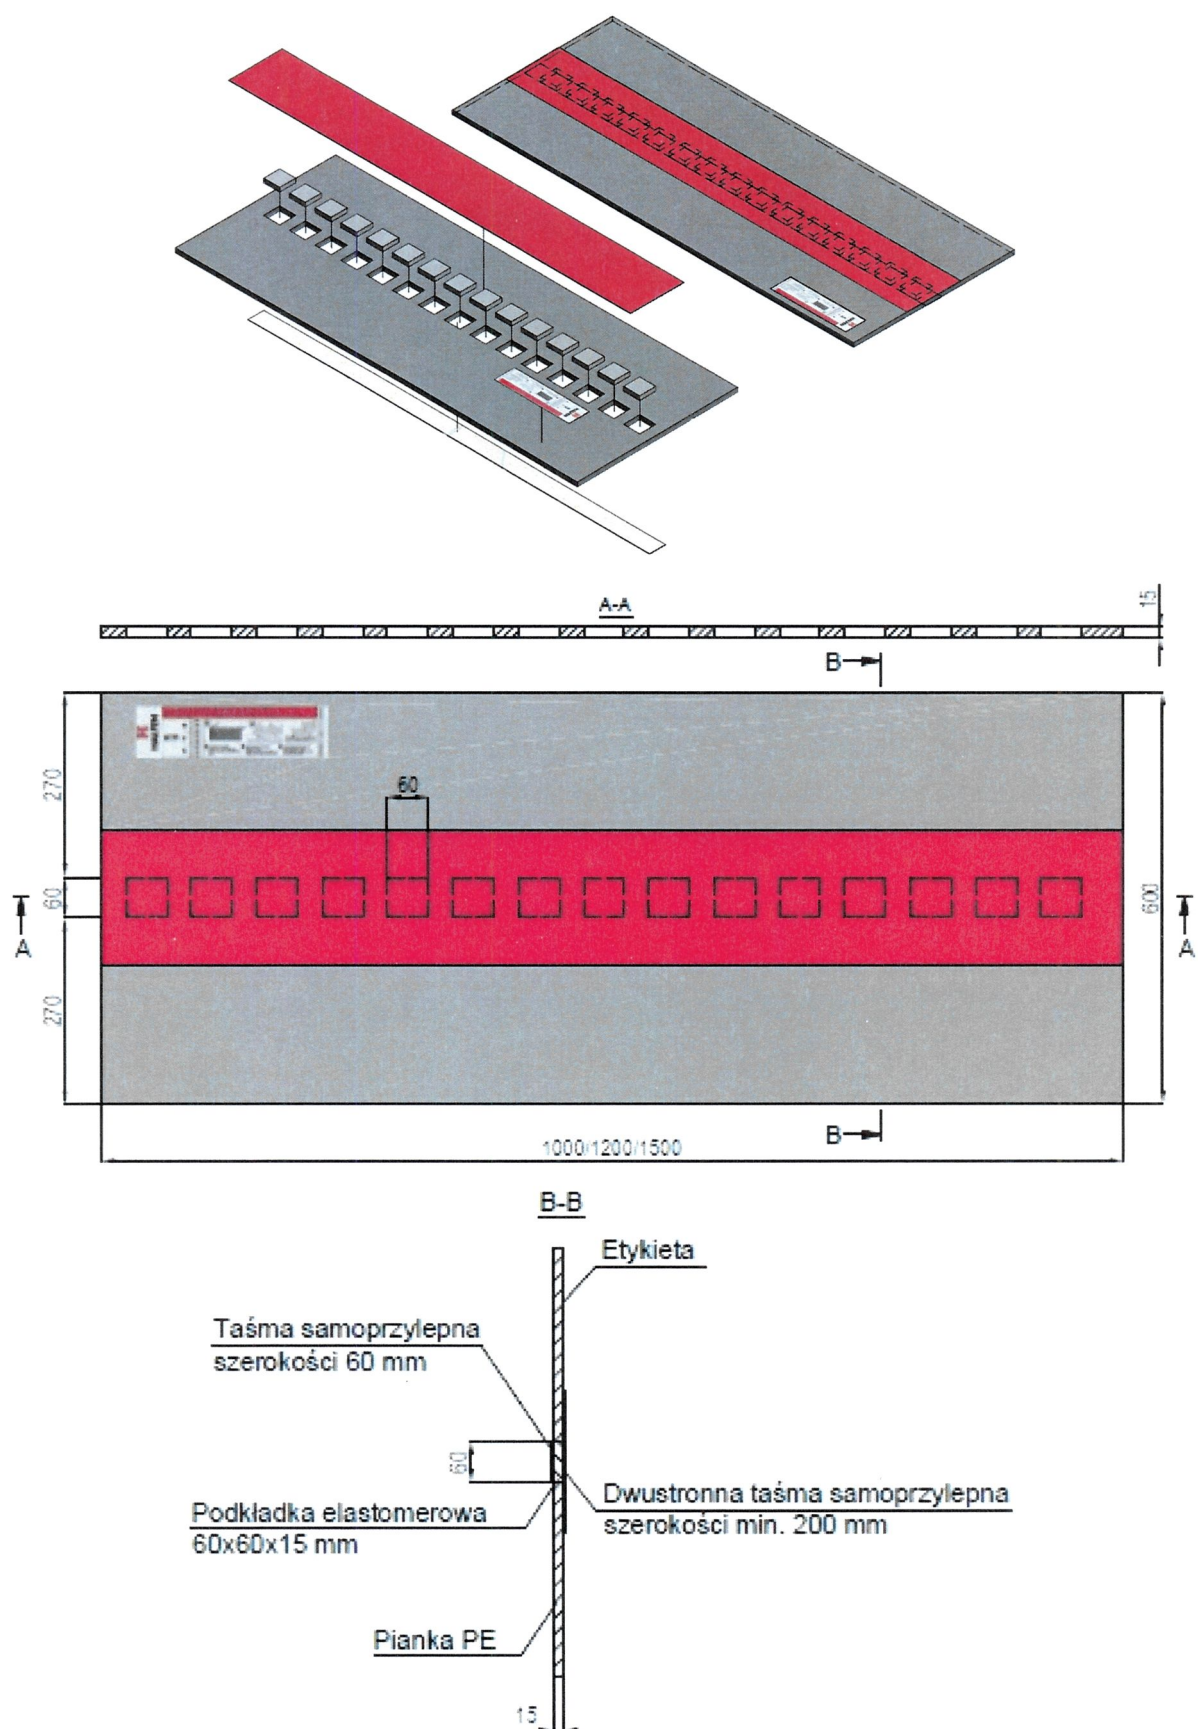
Kształt i wymiary (w mm) elementów HTF-T2
